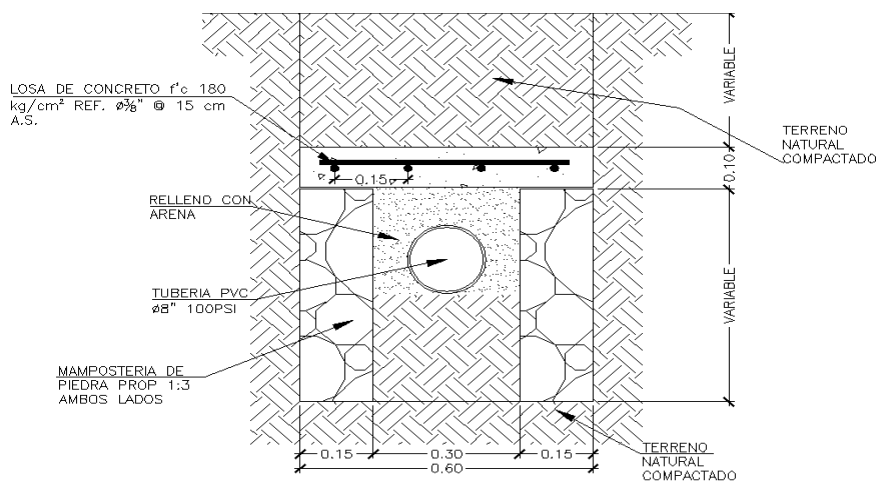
Detalle de protección de tubería vista de sección (fuente ANDA)
